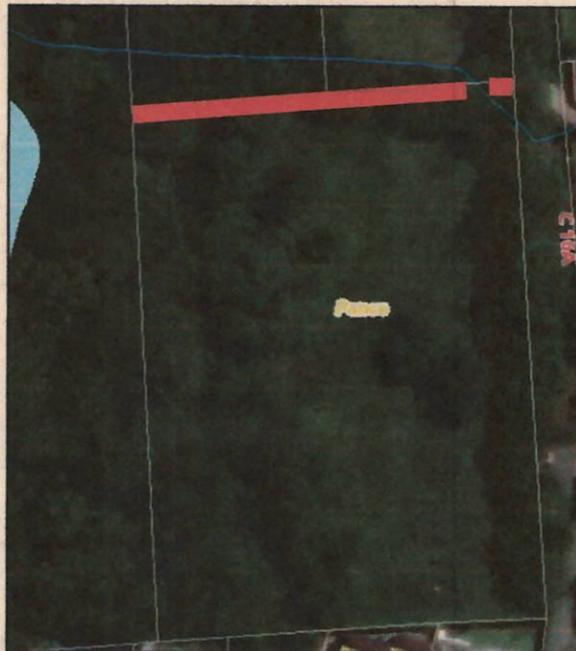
Ubicación del muro perimetral construido en el Proyecto Turmalina
